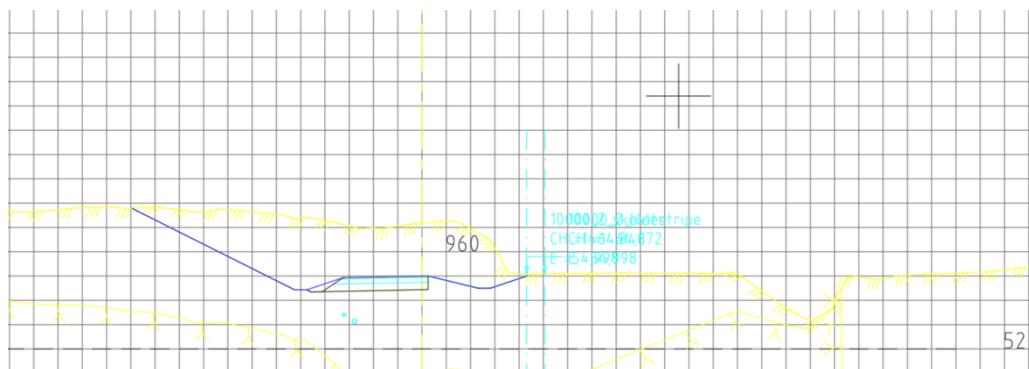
Planlagt tverrprofil ved Åbydalen 2, profil 540.
